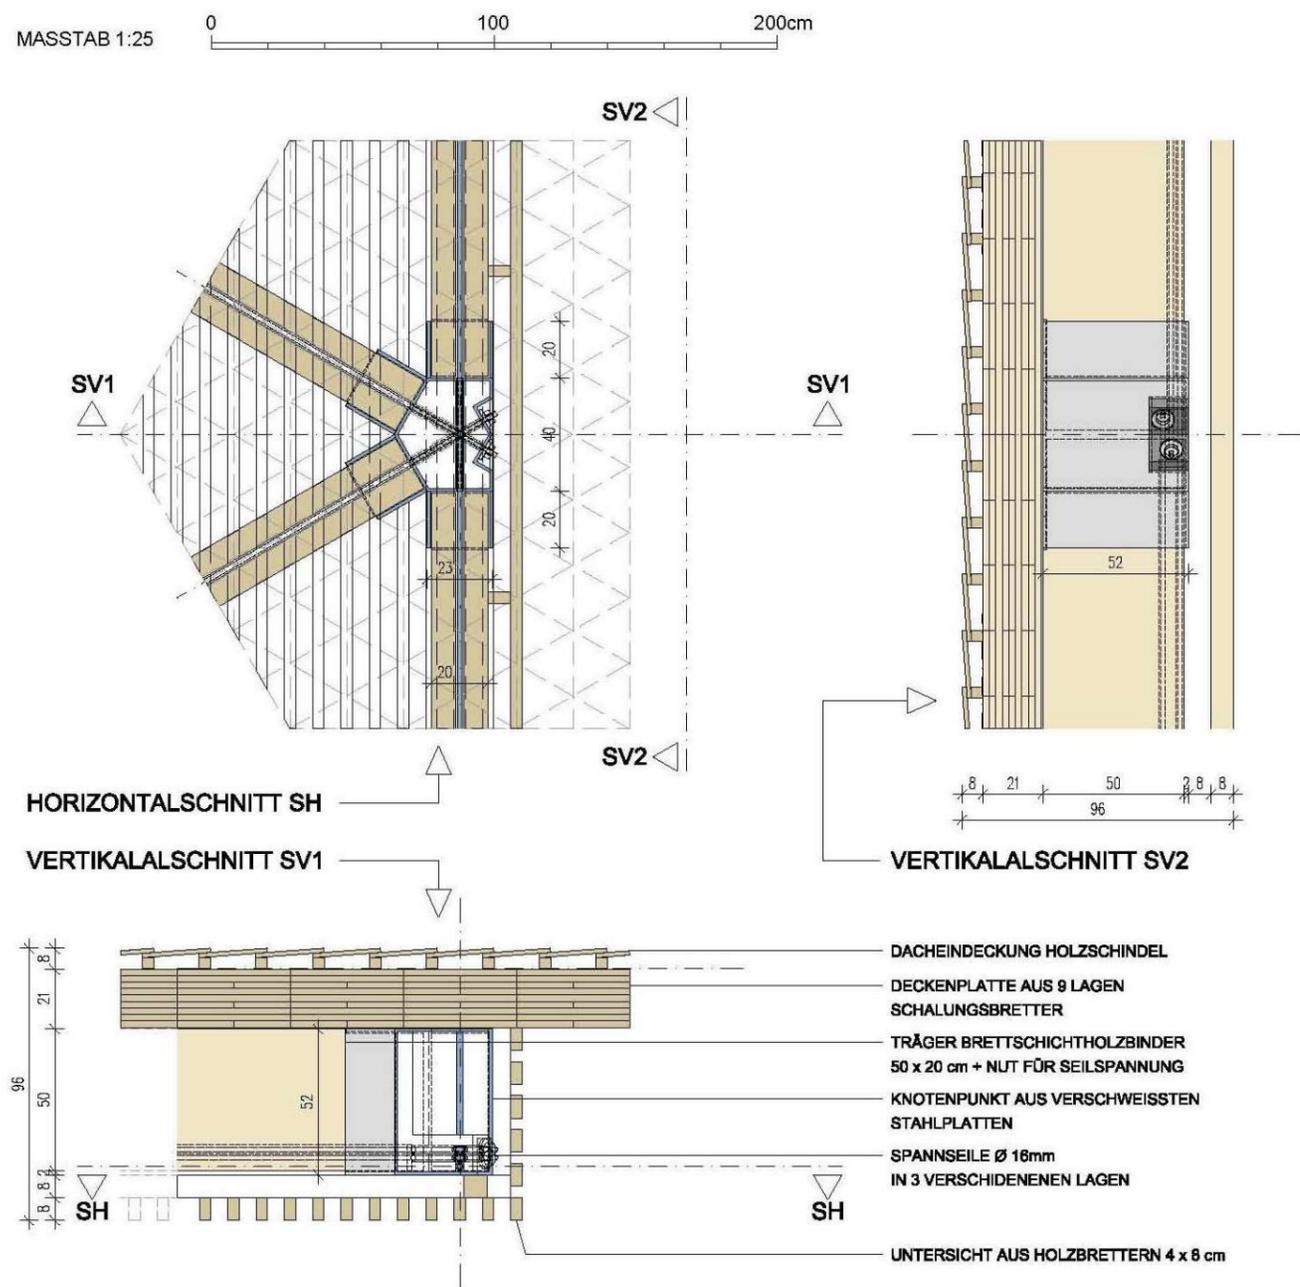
Knotenpunkt 2 - Detailschnitte
